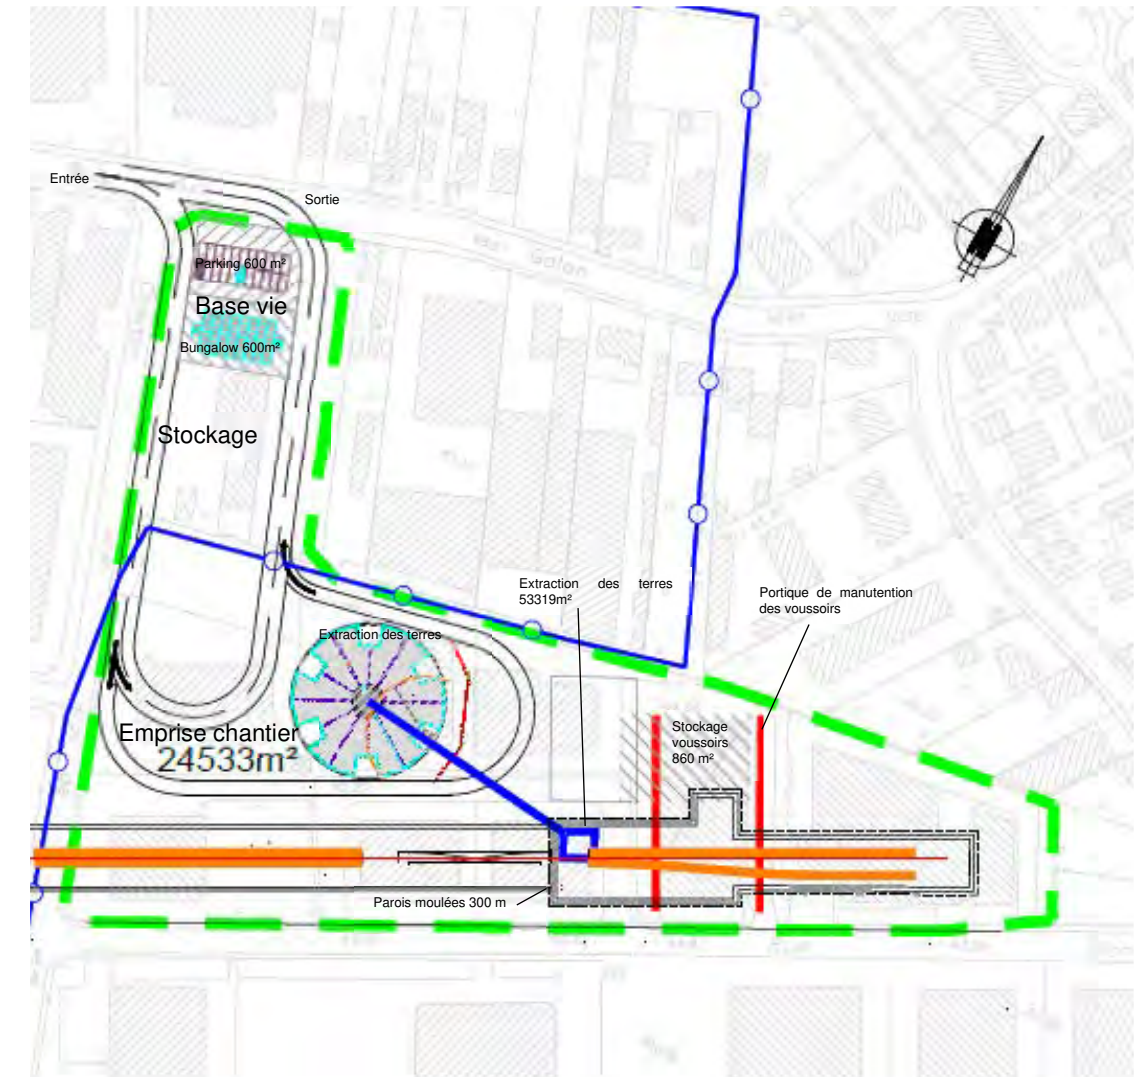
Emprises chantiers du CDT et du puits d'entrée du tunnelier (Source : RATP)
